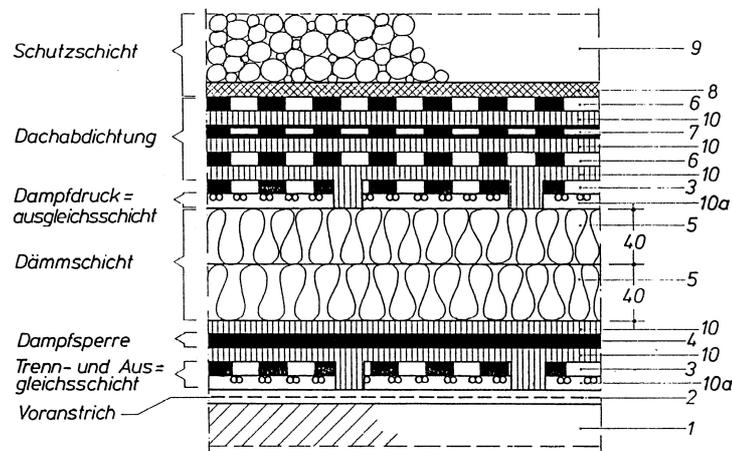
Aufbau eines Flachdaches mit Dachabdichtung (Beispiel)
